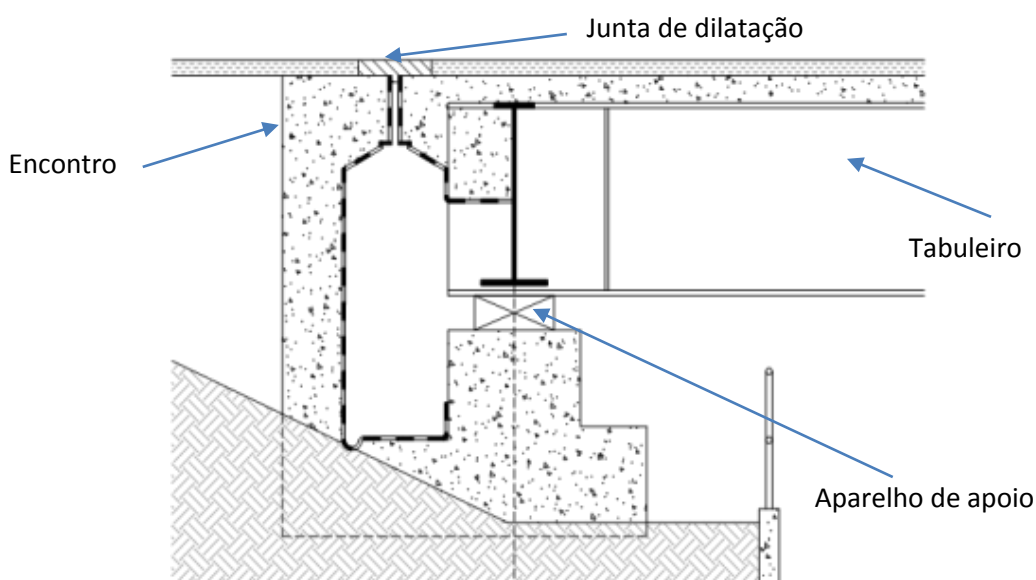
Esquema de um encontro com aparelho de apoio e junta de dilatação (corte vertical) (adaptado de [www.steelconstruction.info](http://www.steelconstruction.info))
